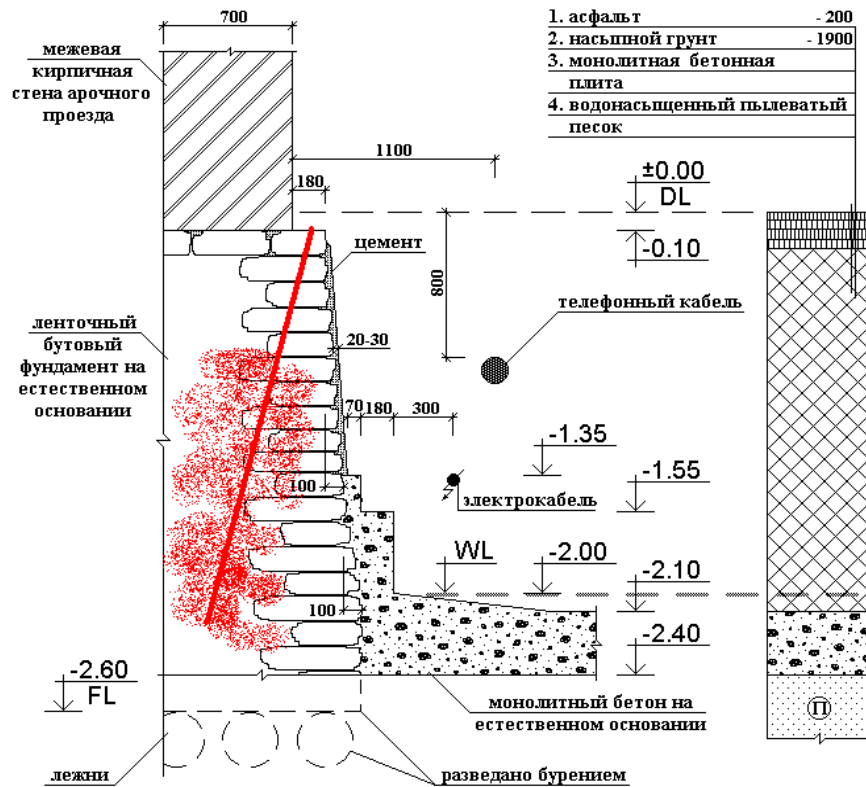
Схема проведения инъекционных работ по усилению тела бутового фундамента с первого этажа здания
